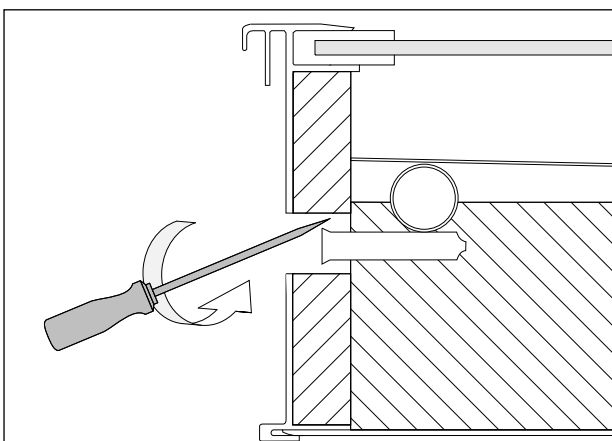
Fühlermontage: Gummistopfen mit Schraubendreher herausdrehen, ggf. Fühlerhülse mit Schraubendreher freilegen.
